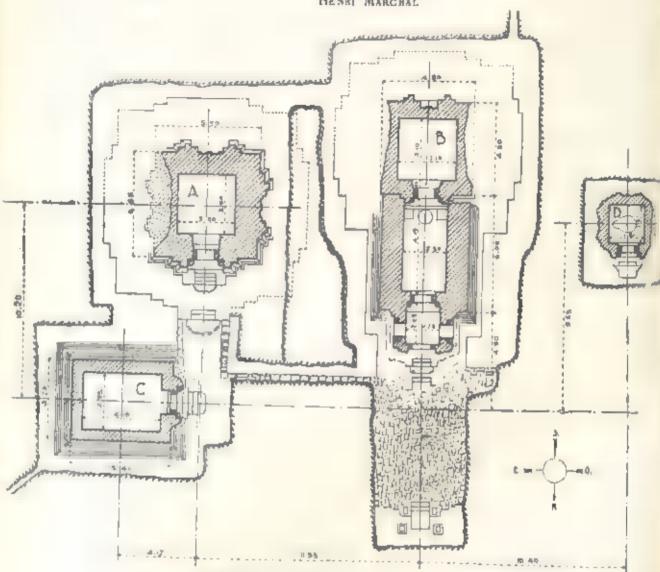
PRANT Kon Po Plan den sanetunires.
